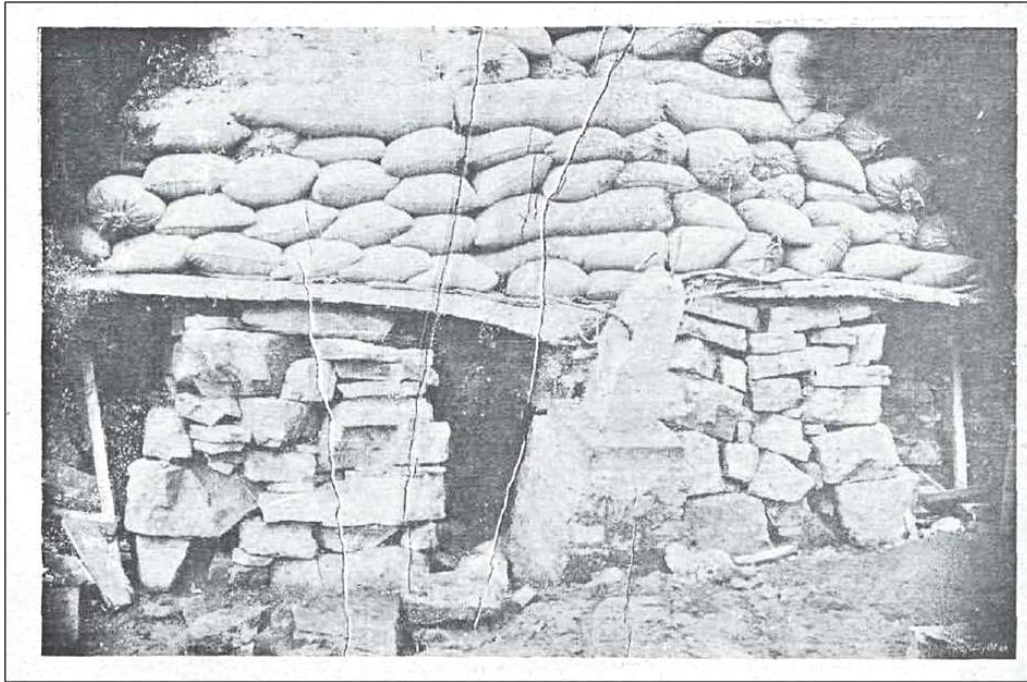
Momento en el que la estructura cede a causa de la sobrecarga. Revista La Construcción Moderna No.12 año 1903
